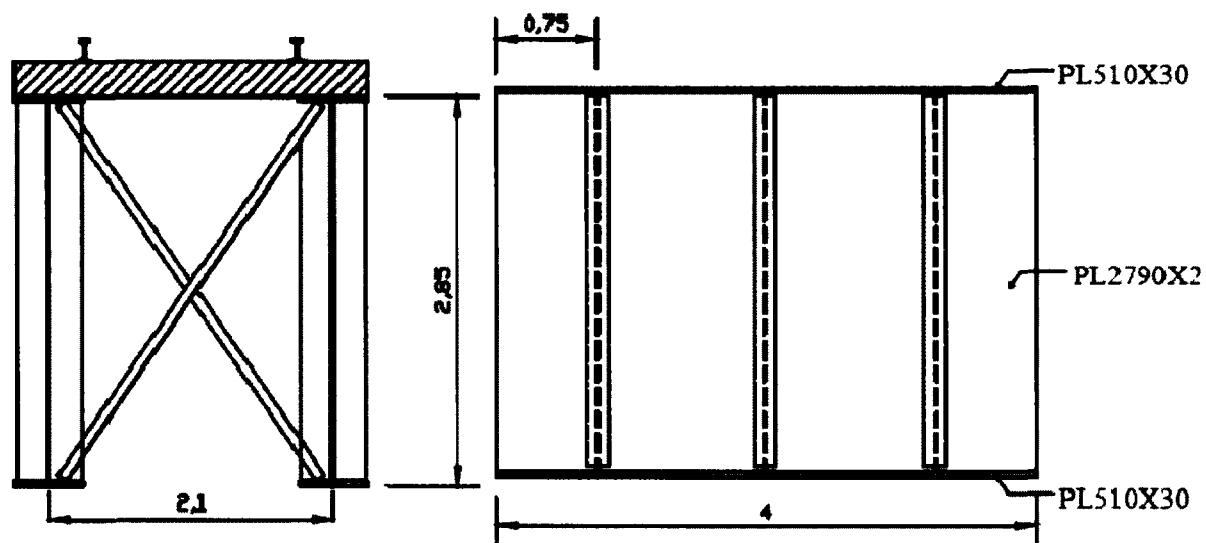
Pont bi-poutres - Section transversale et élévation - Section E-3
